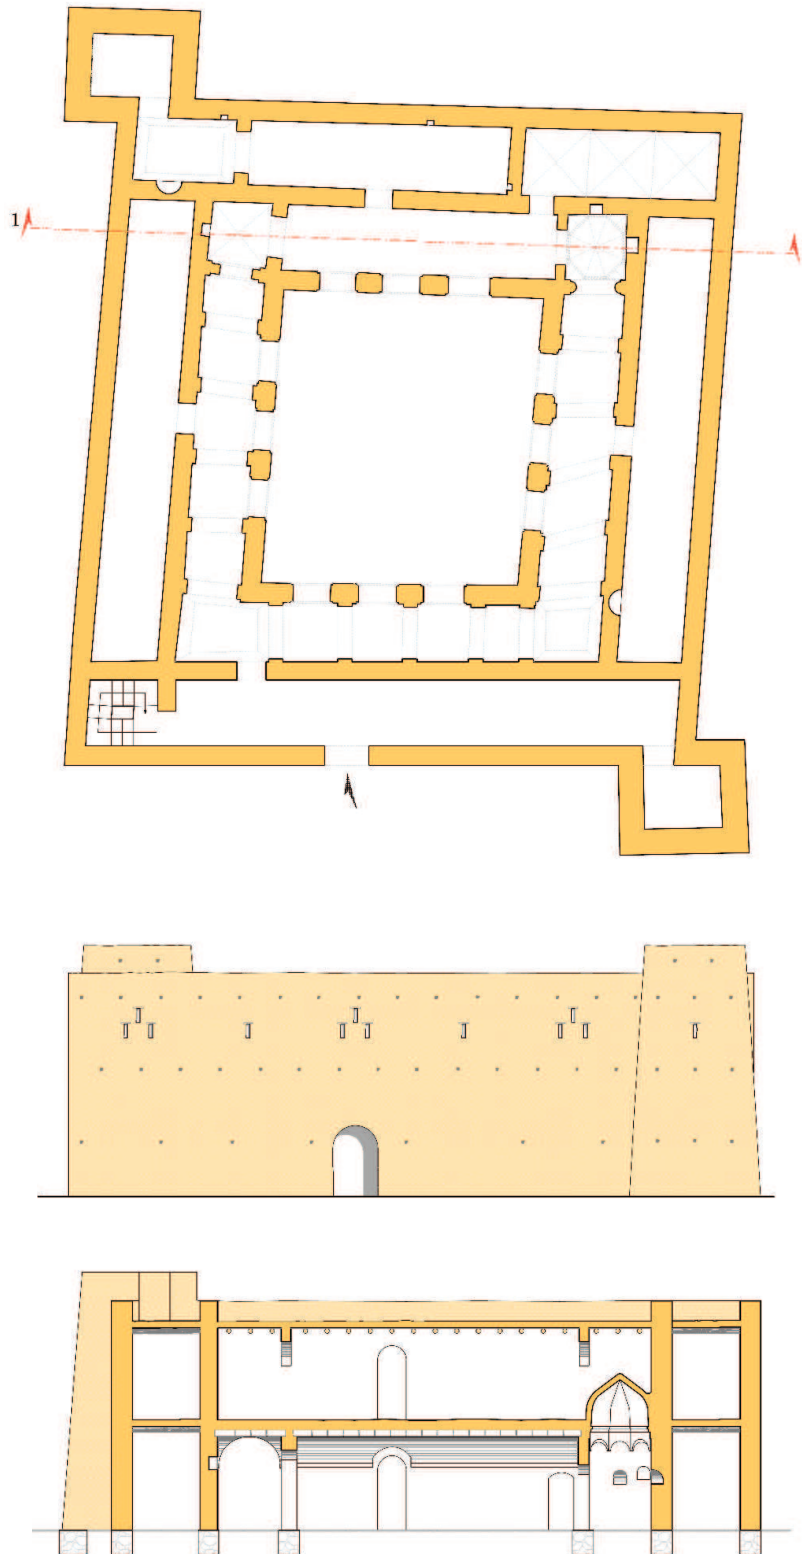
Vue en plan, façade et coupe de Dar Eddeymanī, (échelle : 1/200).
